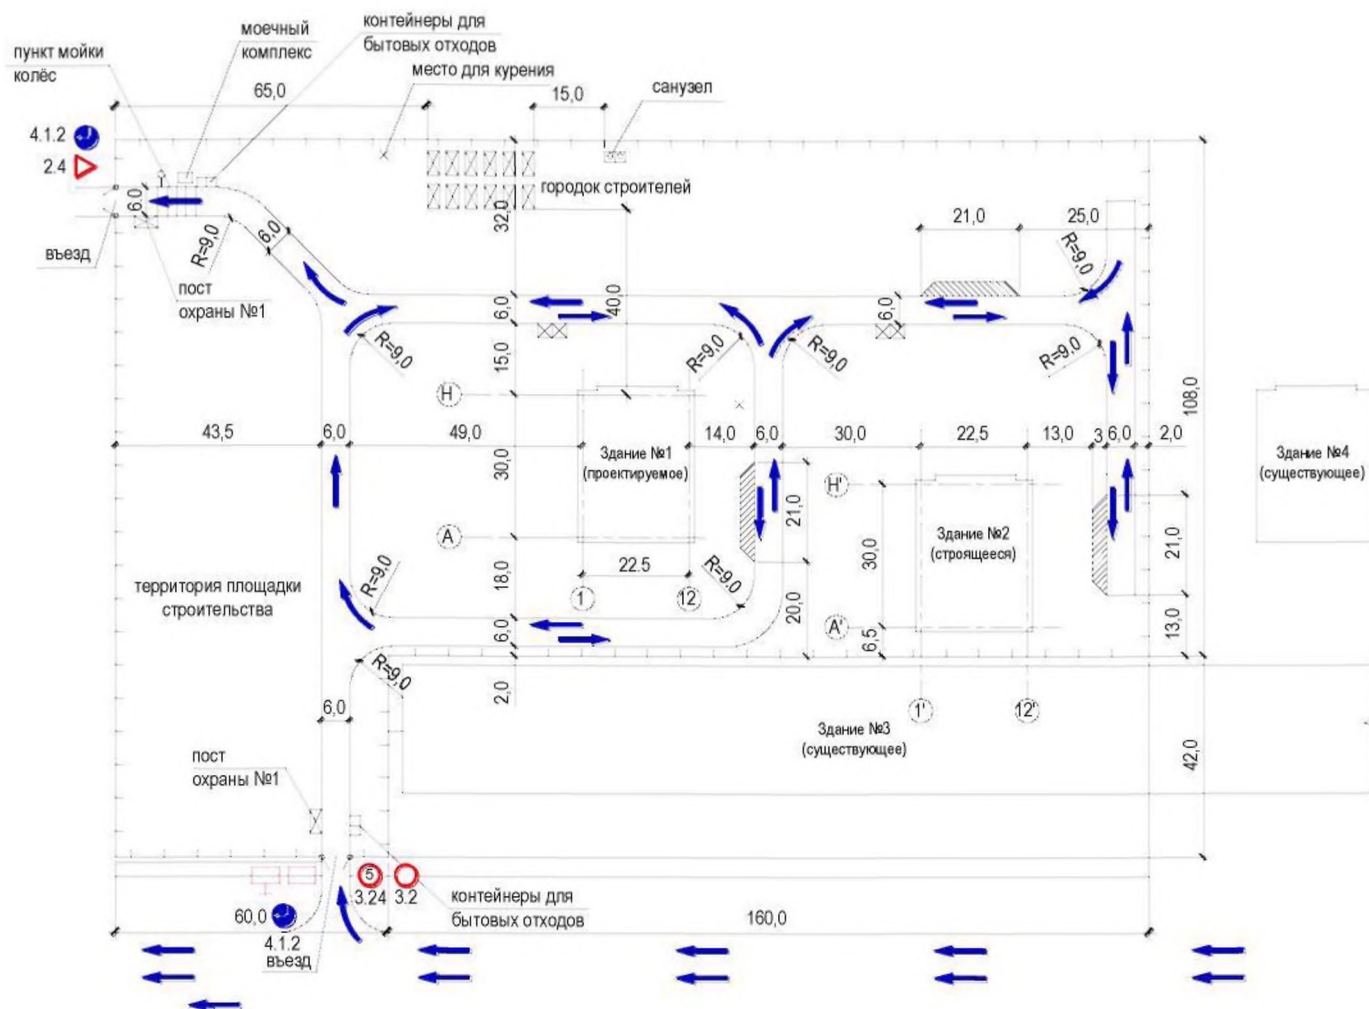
Схема размещения пункта мойки колёс на стройплощадке
